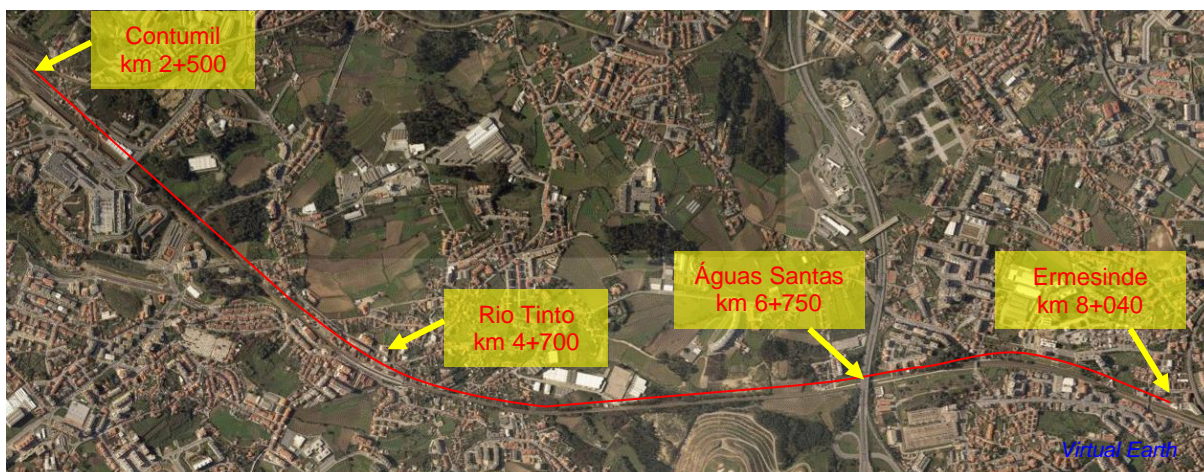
Planta de localização da Quadruplicação do Contumil-Ermesinde .....	1
